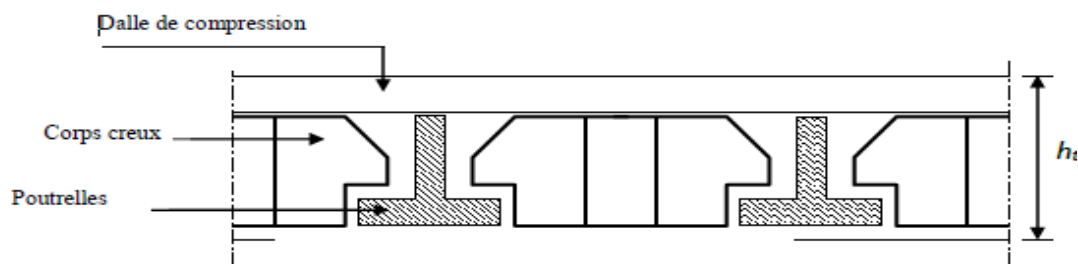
Coupe transversale d'un plancher à corps creux.
